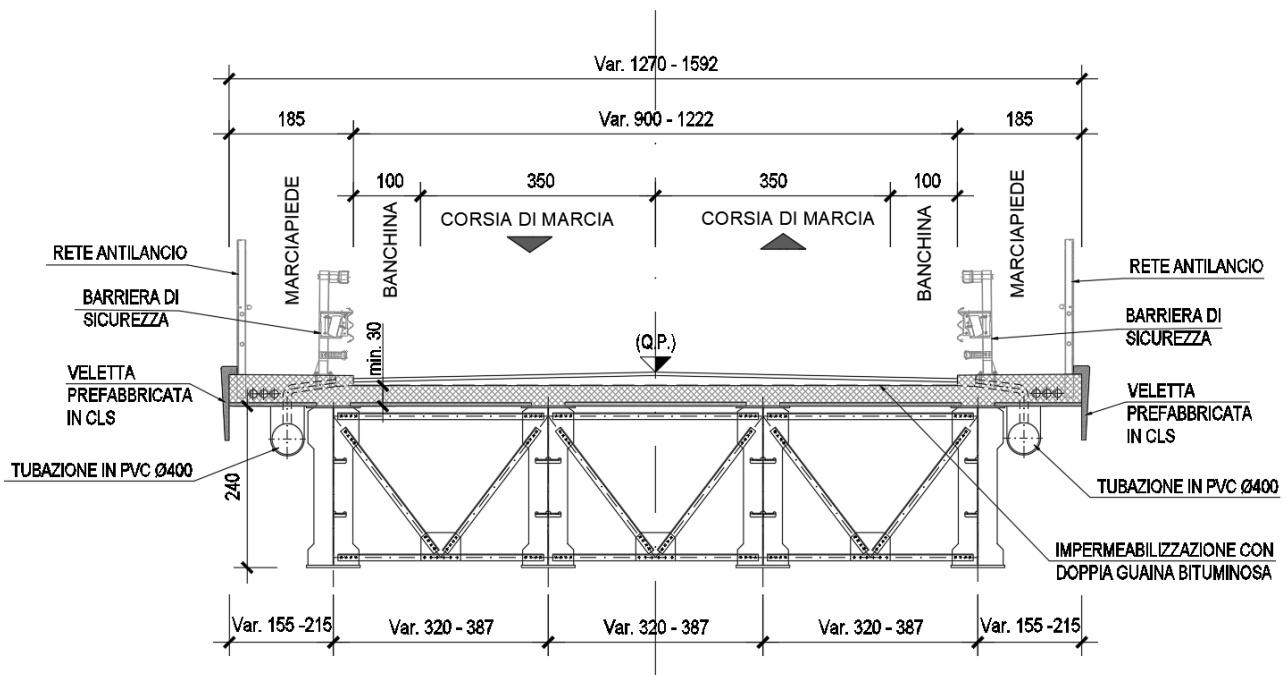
Sezione trasversale campata (travi H=2.40m)
